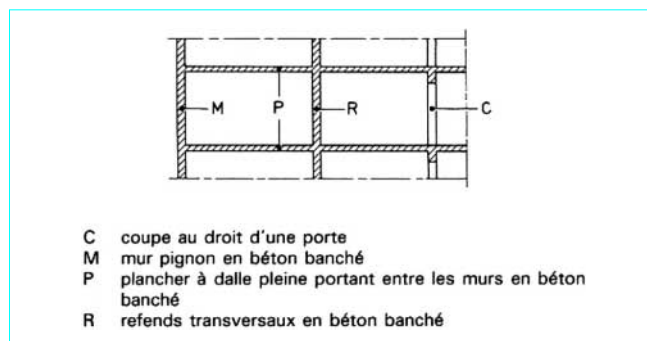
Plancher à dalle pleine entre refends transversaux porteurs en béton banché (élévation)
